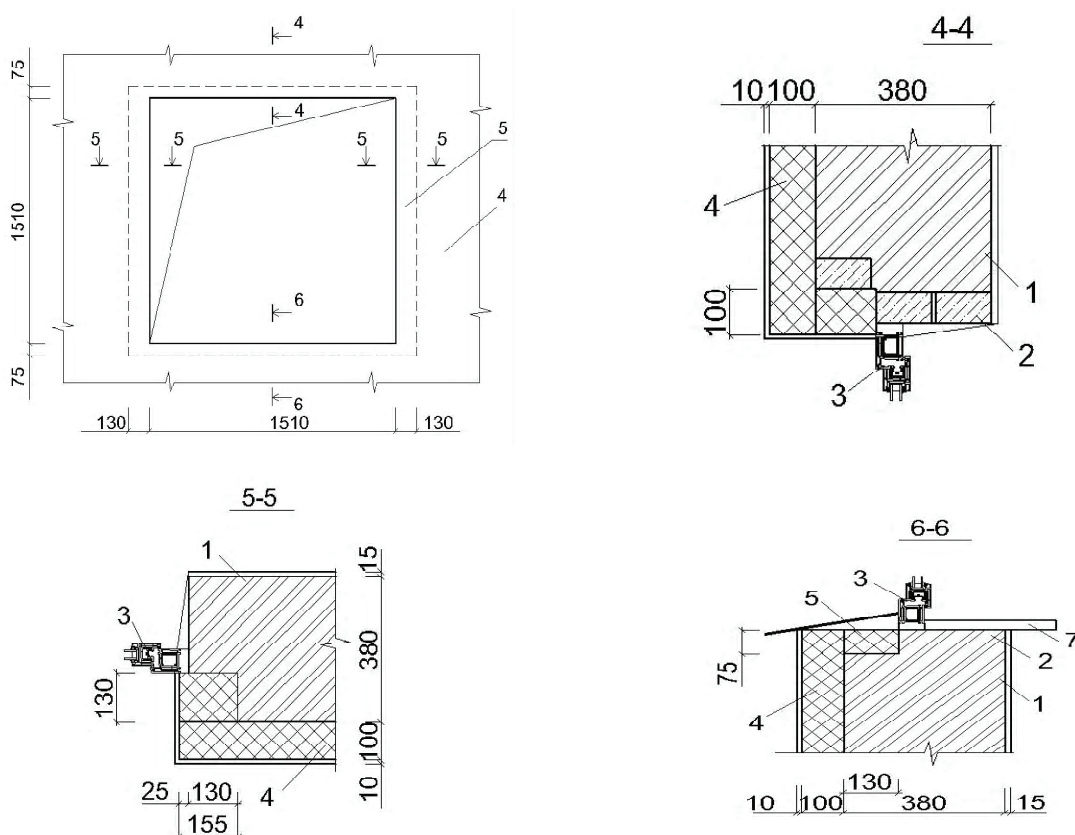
Конструктивное решение оконного проема с углублением в кирпичной стене: 1 – наружная стена, 2 – железобетонная перемычка, 3 – оконное заполнение, 4 – внешняя теплоизоляция, 5 – дополнительный слой утеплителя в углублении проема, 6 – слив, 7 – подоконник.
